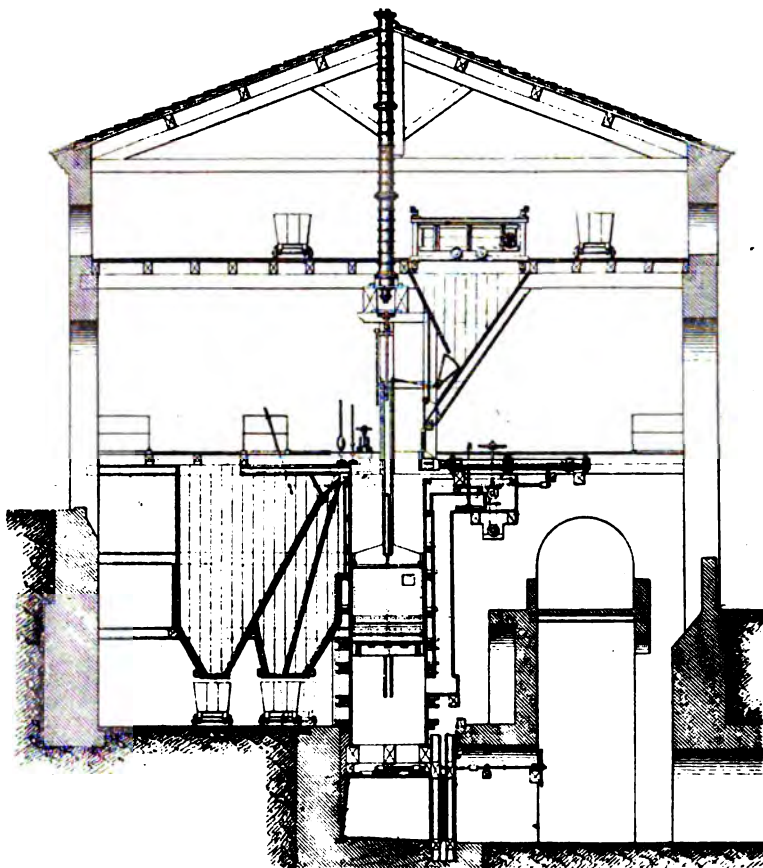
Lavoir Marsaut (coupe longitudinale).
